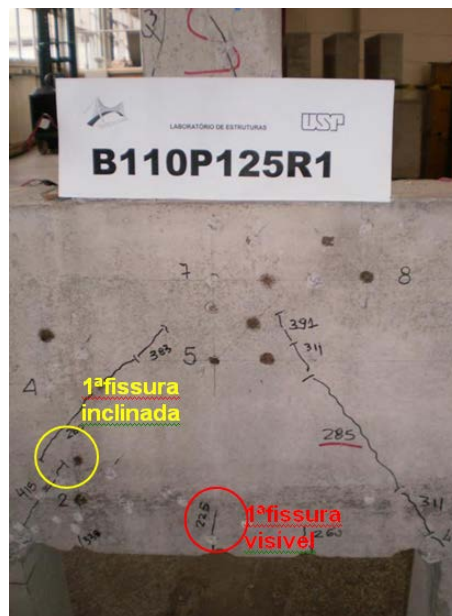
Primeiras fissuras anotadas no modelo B110P125R1
